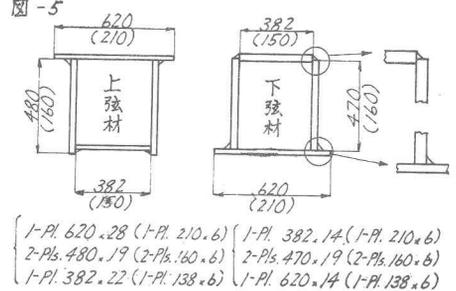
型式と図-5型式の試験体を製作し、上弦材は圧縮試験、下弦材は曲げ試験を行った。
